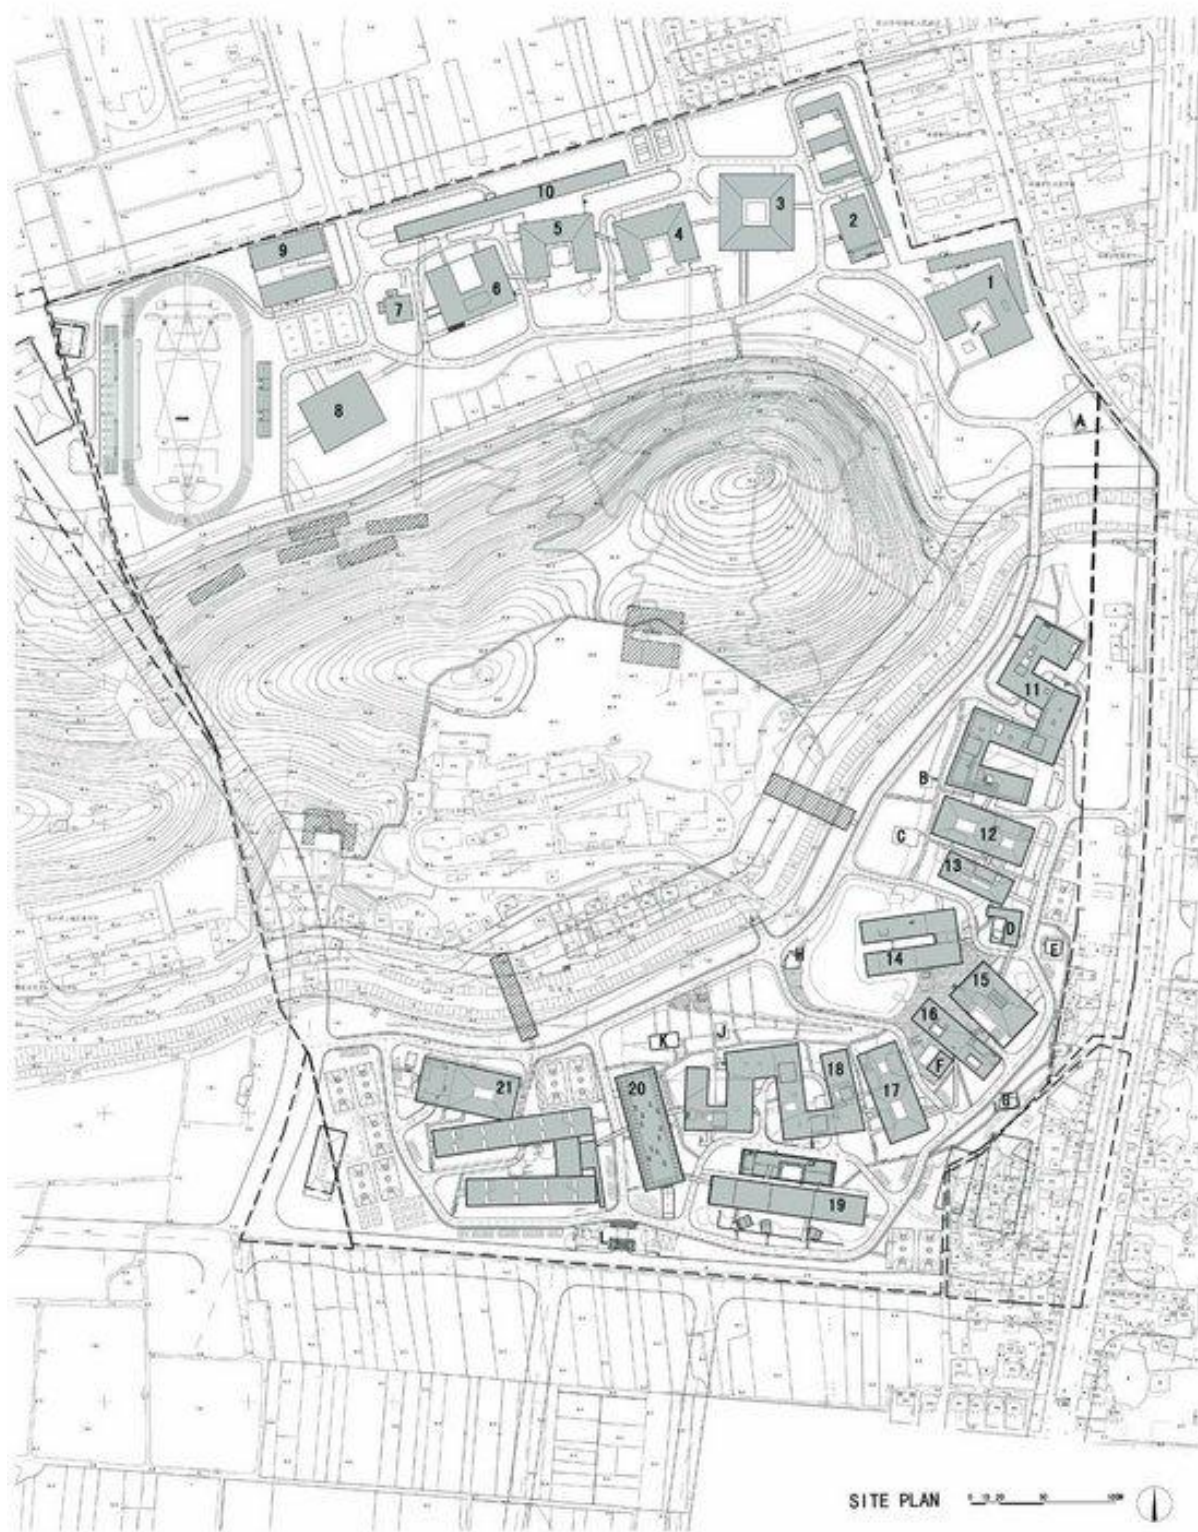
Plano del Xiangshan Campus en Hangzhou
